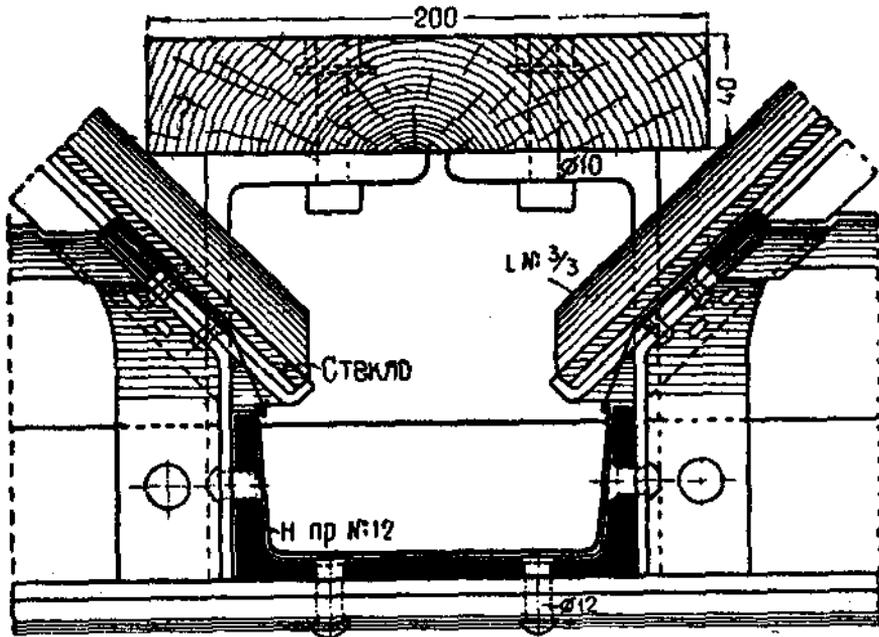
устройство желоба между двумя застекленными скатами световых фонарей. Вся поддерживающая конструкция металлическая. Желоб образован набитием бетона. Уклон желоба сделан с помощью постепенного утолщения и утонения бетонного слоя стенок вдоль
